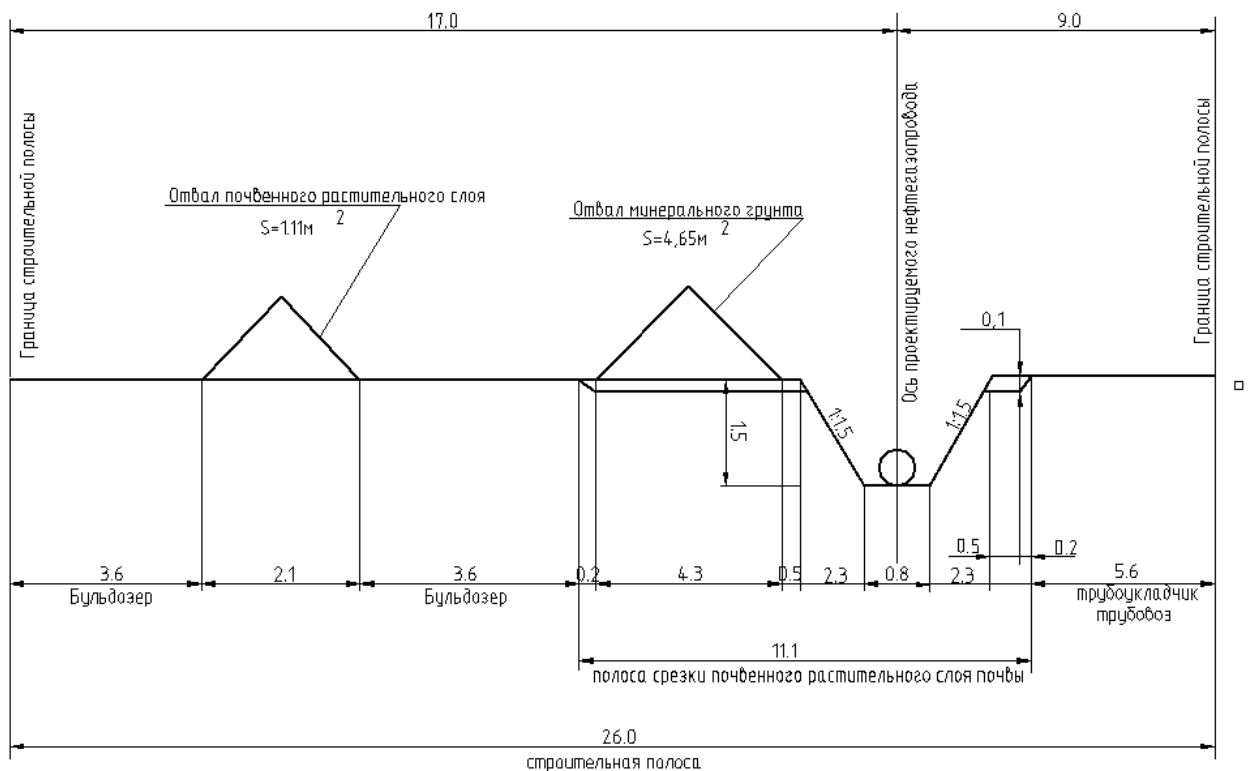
Схема строительной полосы при строительстве нефтегазопровода
